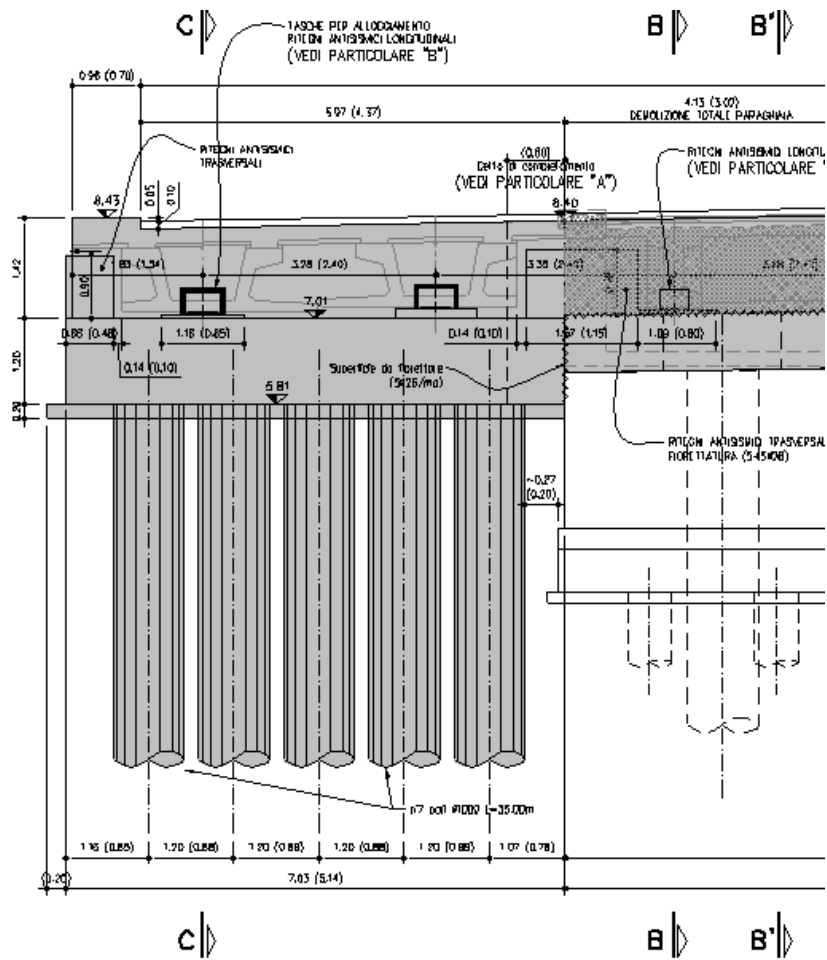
Semi-prospetto spalle con ampliamento
